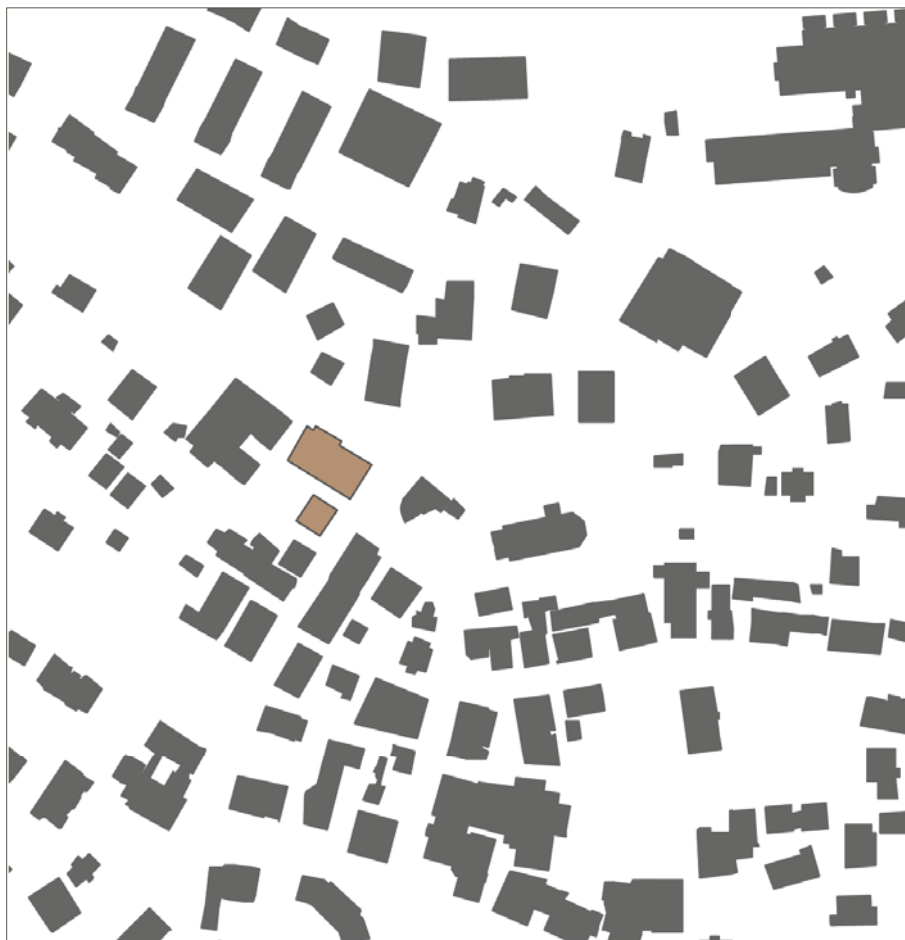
Städtebauliche Einordnung mit Gebäudeabdrücken im Schwarzplan
